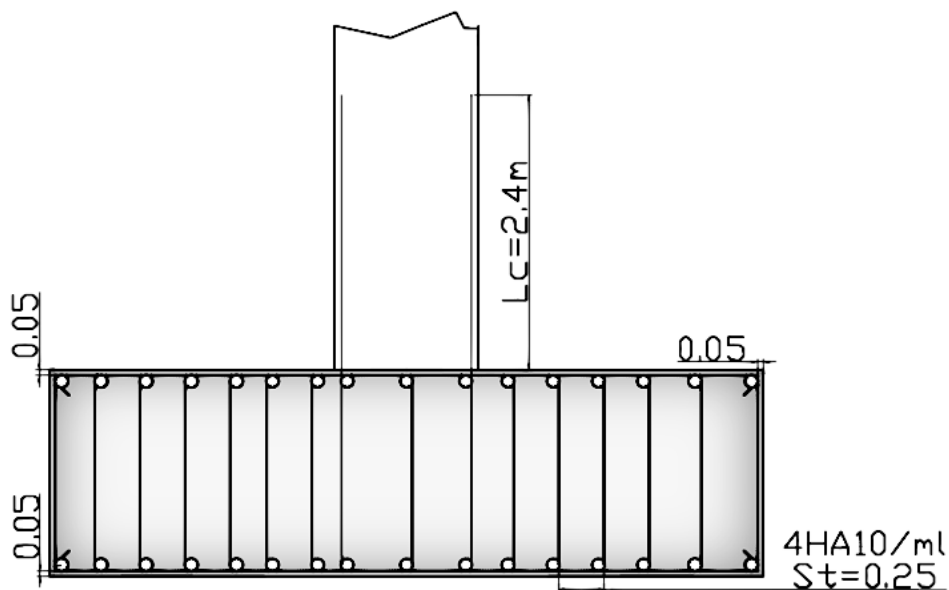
Coupe transversale du ferrailage de la semelle.
